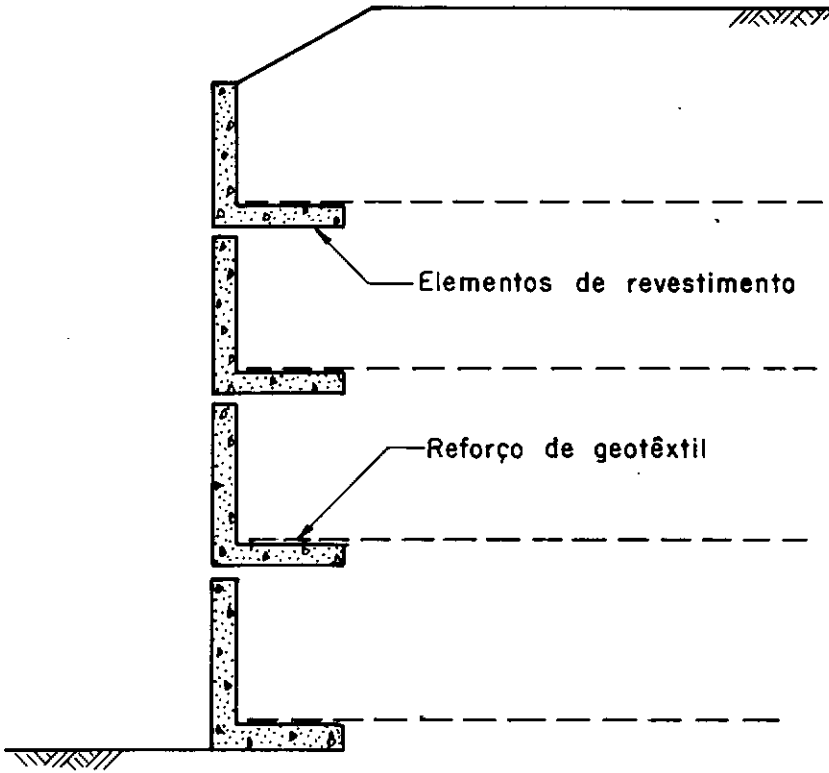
Estrutura de solo reforçado concebida por BROMS (1978)
